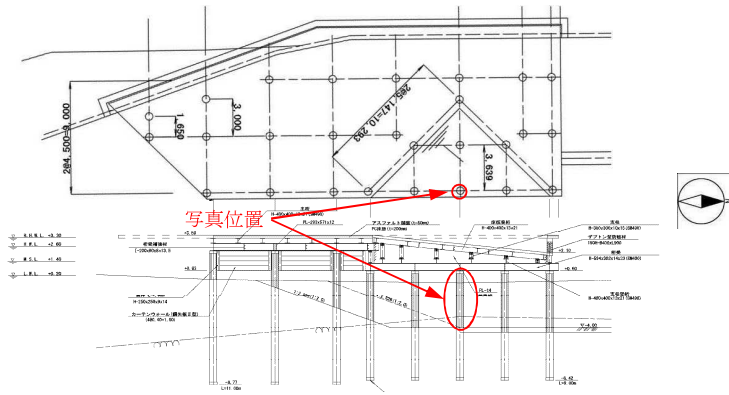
搬出入施設・車両乗降部 平面・横断面図 (下部工：海水面より下)
